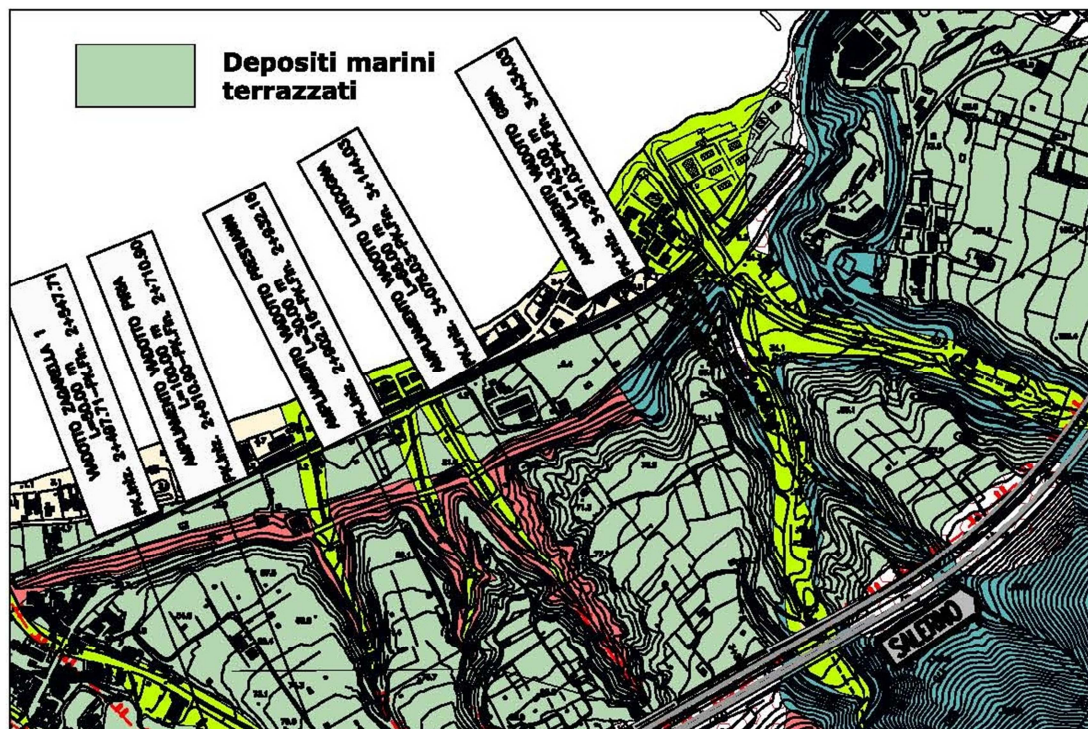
Planimetria geologica del progetto del Ponte sullo Stretto
